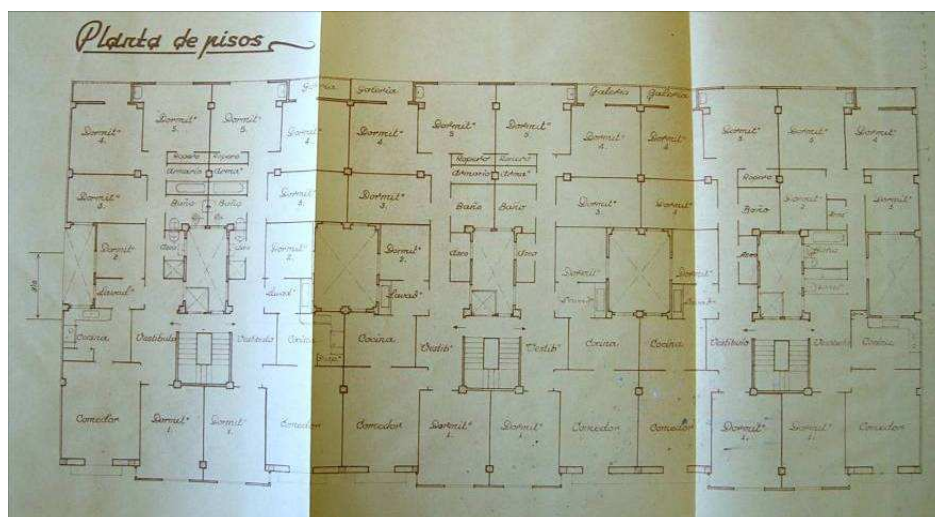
Planta de distribución. Edificio ficha 79C.005
